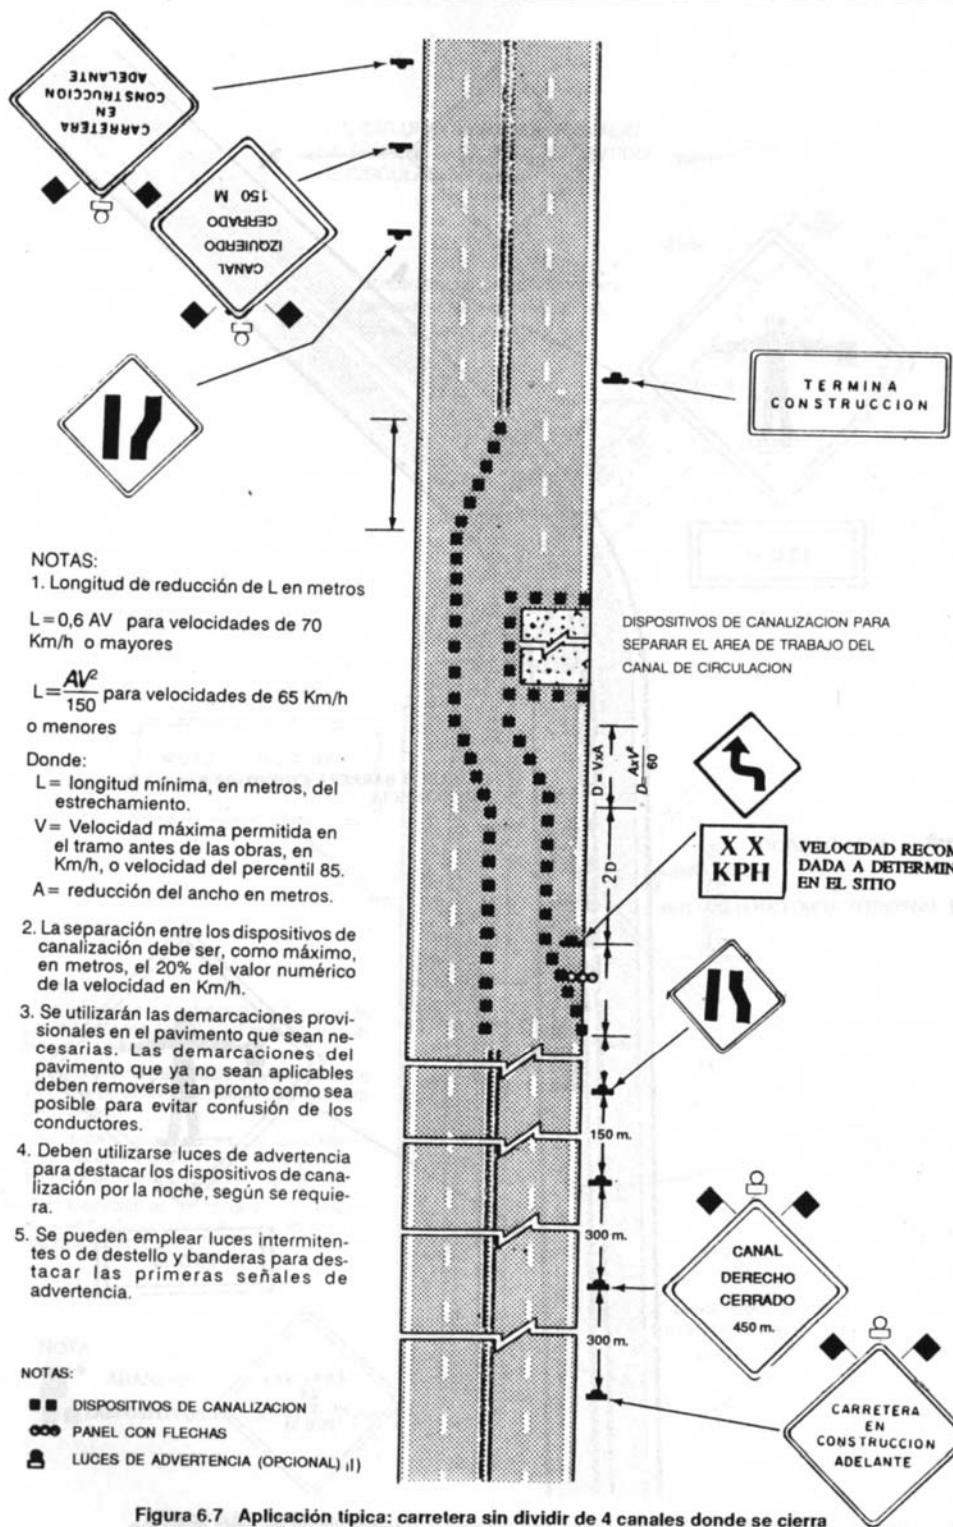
Aplicación típica: carretera sin dividir de 4 canales donde se cierra la mitad de la calzada.
